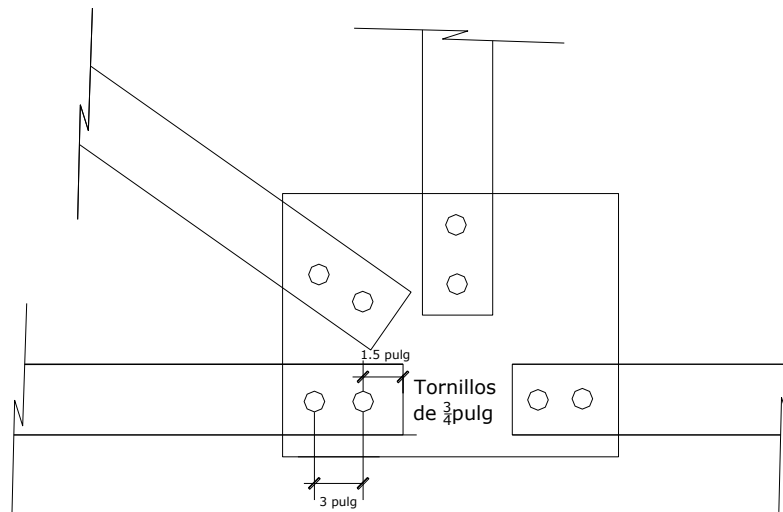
Detalle de la conexión emperrada en el nudo de la armadura.
